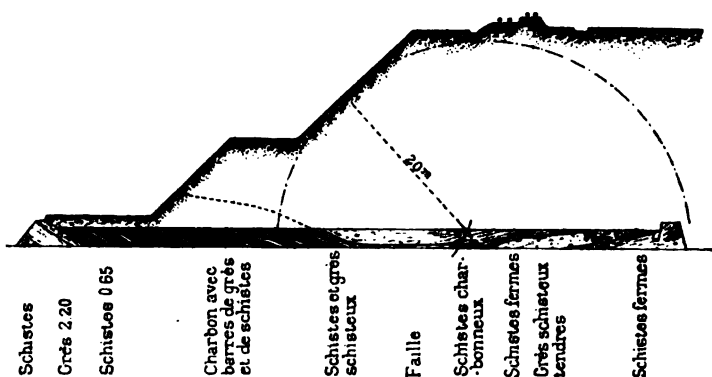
Carrière Sainte-Élisabeth. — Coupe de la galerie prise au fond de la carrière. Echelle: 1/750^e.
